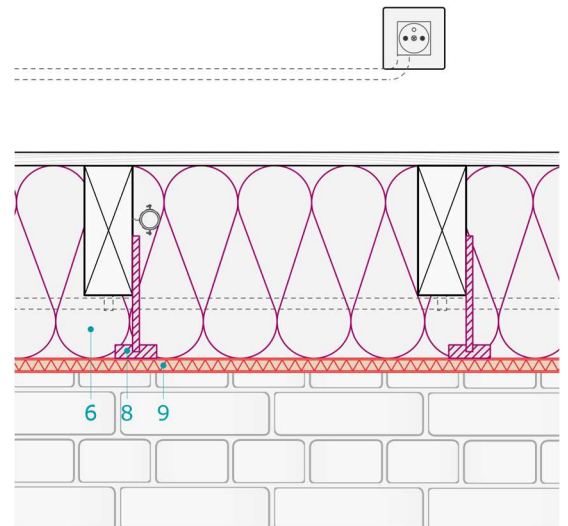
Détail mur – plancher en bois sur cave - coupe verticale parallèle à la façade
